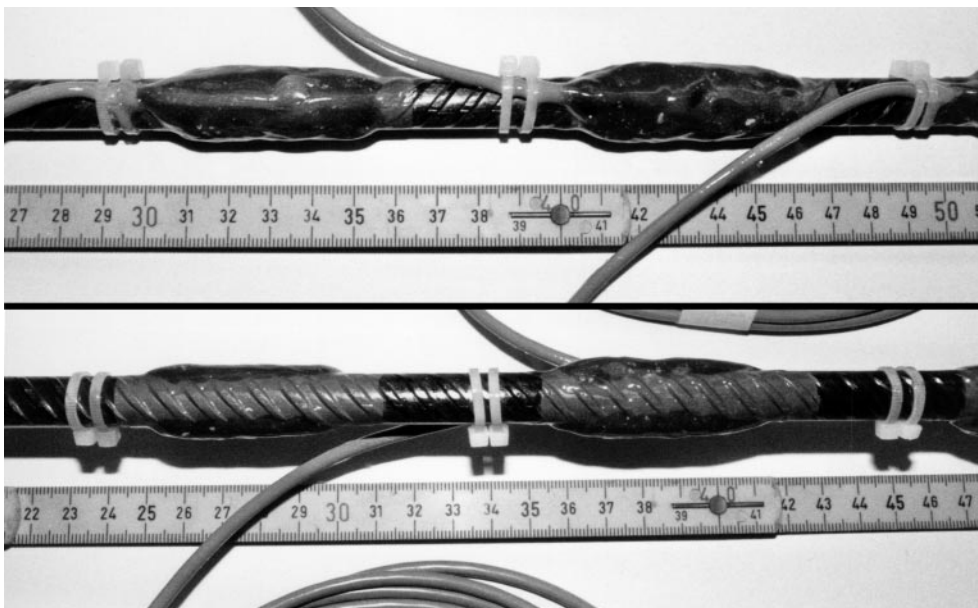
Dehnmessstreifen, die an einem Bewehrungsstab $\varnothing 12 \text{ mm}$ angebracht sind. Im Vergleich zum oberen Bild ist im unteren Bild der Bewehrungsstab 180° um die Längsachse gedreht.
